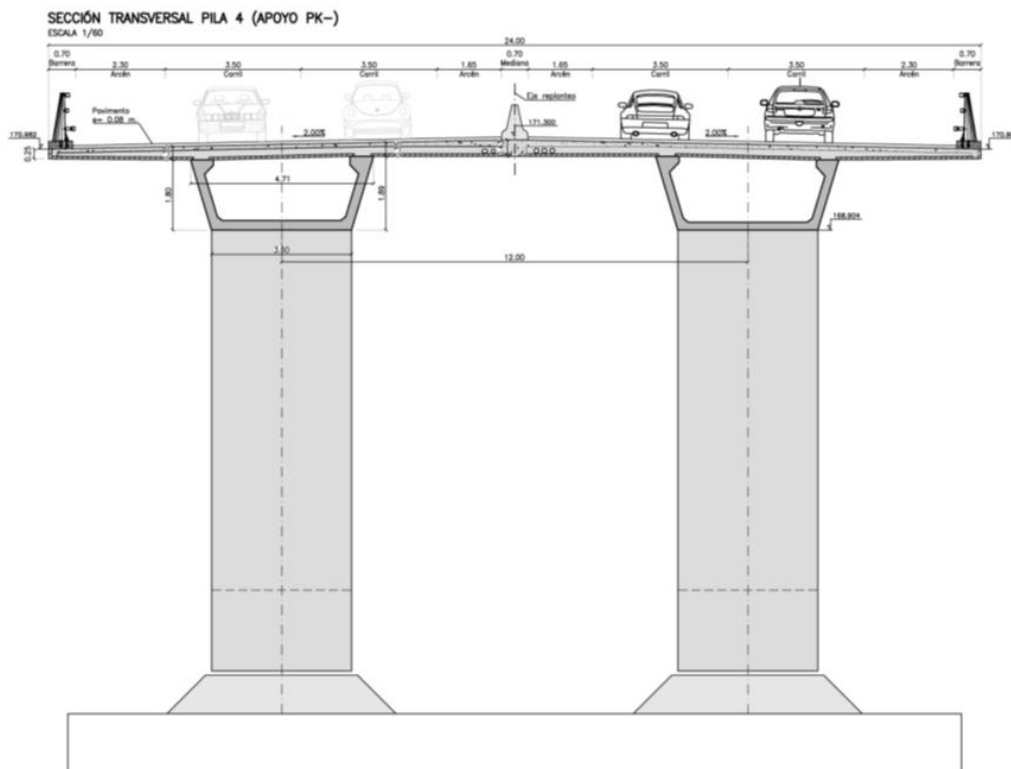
Planos de las secciones transversales del tablero en apoyos. (Fuente: Planos anteproyecto)
